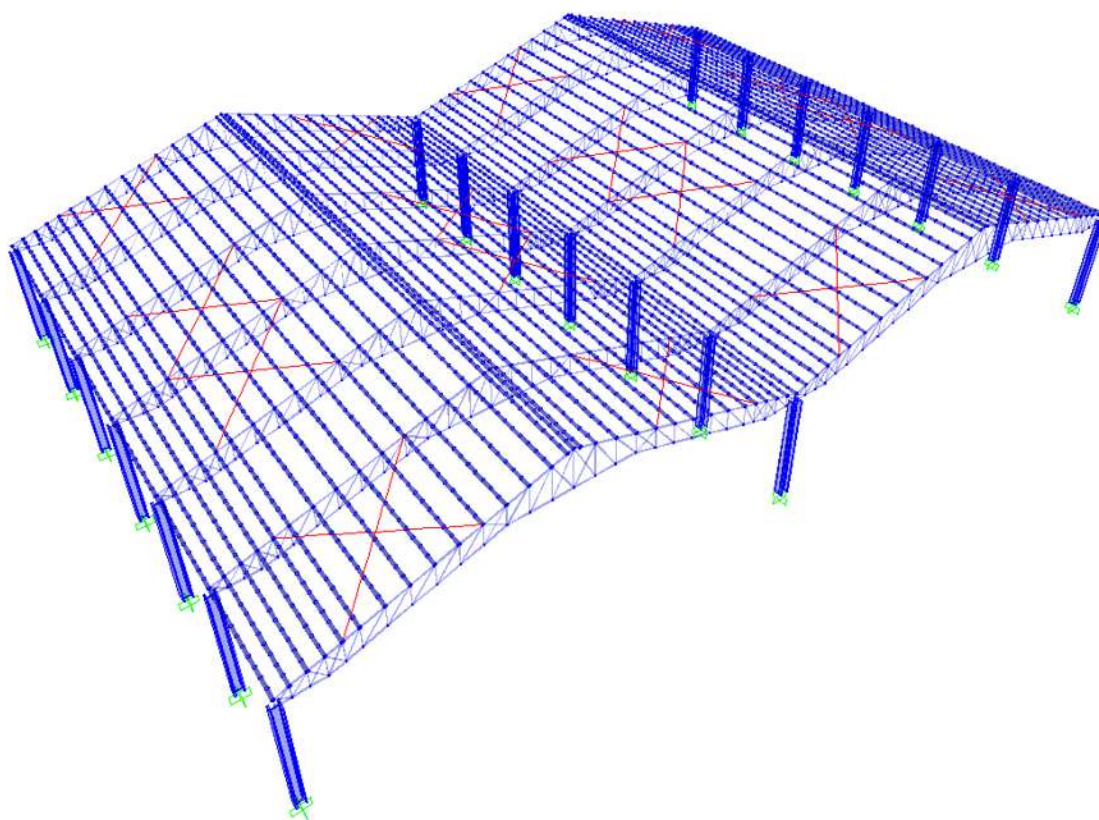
(b) Sistema estructural para la cubierta a dos aguas
